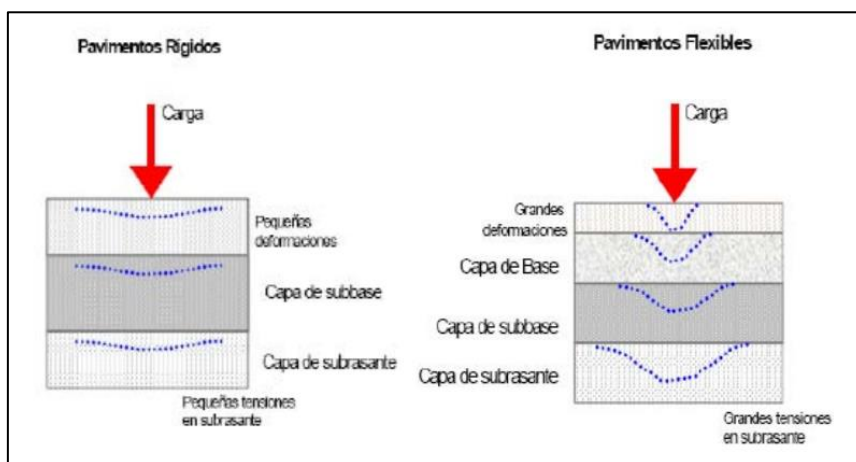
Tensiones generadas por cargas móviles en la estructura de pavimento rígido y flexible. Fuente: (Miranda, 2010).
